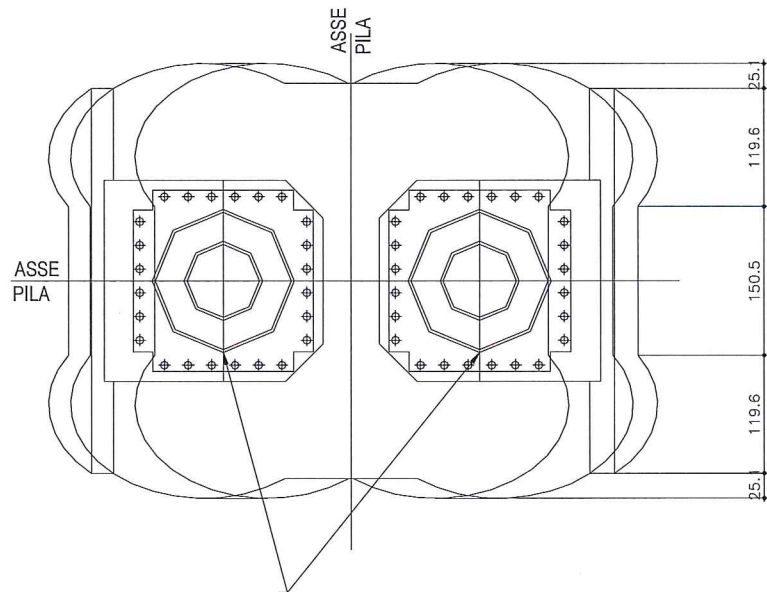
Prospetto trasversale pila tipo (P15).
